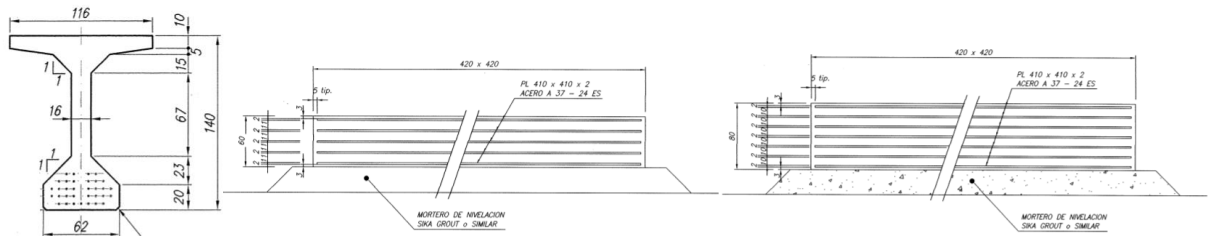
Planos de vigas y elastómeros de puente Águila Norte. Planos Puente MOP [53].
